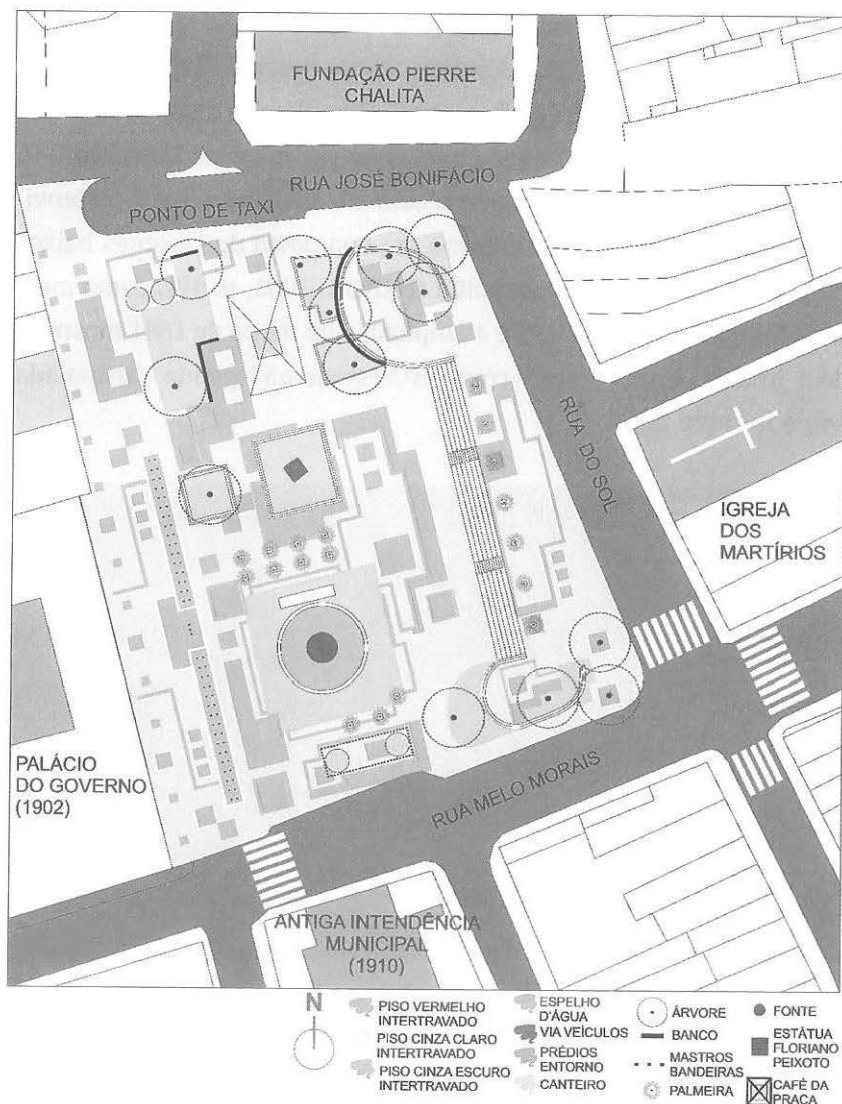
M5 - Planta baixa do projeto de reforma da Praça Marechal Floriano Peixoto. Fonte: Serveal (2002, adaptado)
